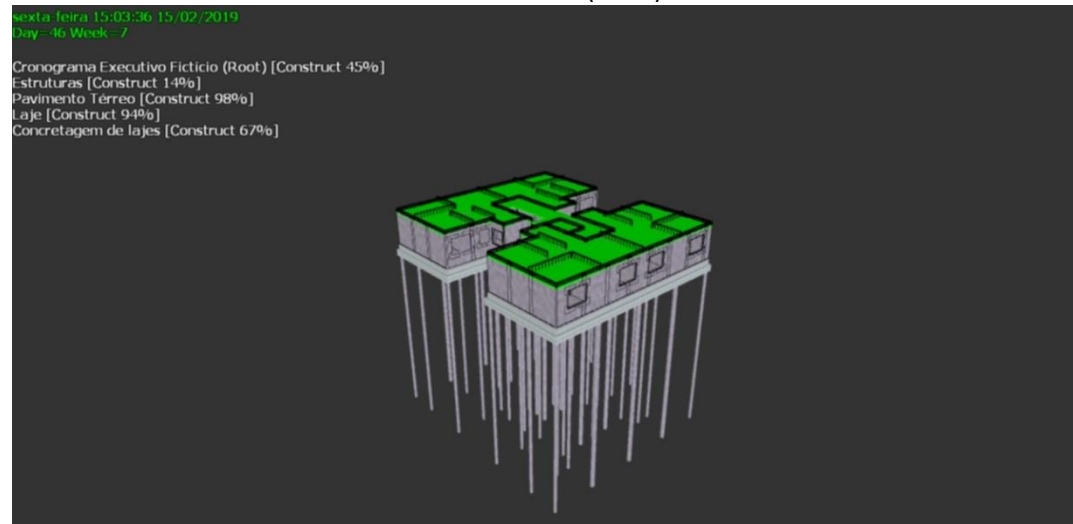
Concretagem da laje do pavimento térreo em execução.
